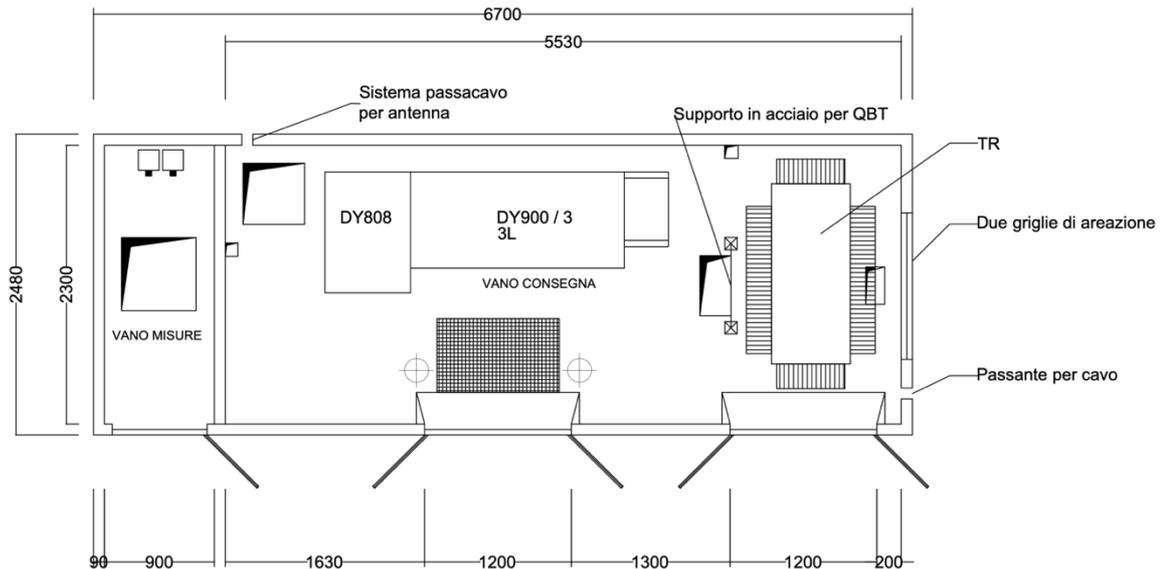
Planimetria del locale Gestore e del vano misure delle cabine di consegna secondo DG 2061/7 ed. 9
